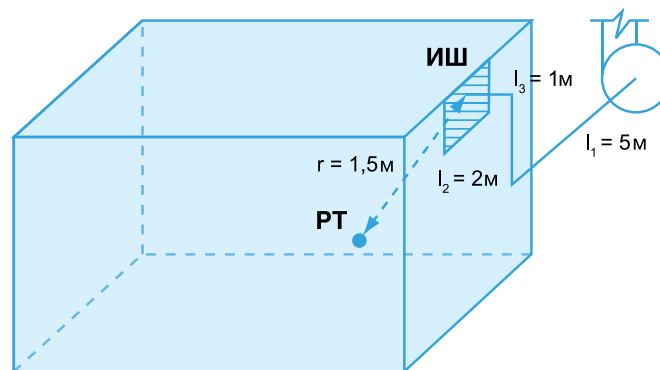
Расчетная схема для определения уровней шума в помещении при работе вентиляционной системы
